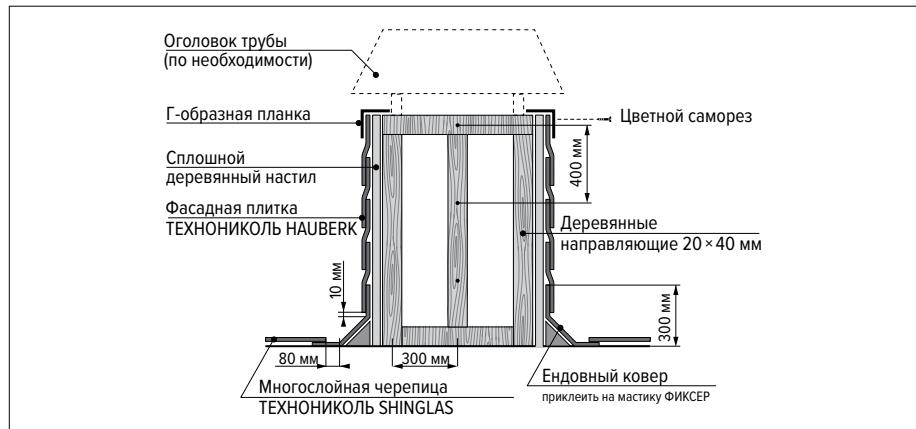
Монтаж фасадной плитки на вентиляционную трубу
